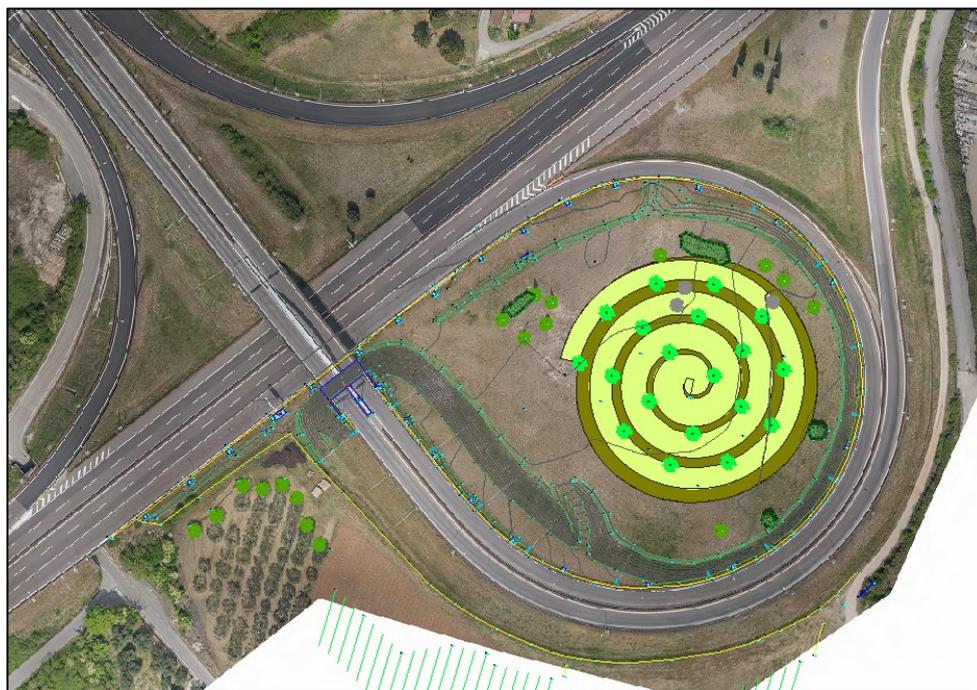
Planimetria schematica dell'intervento nello svincolo di Affi
